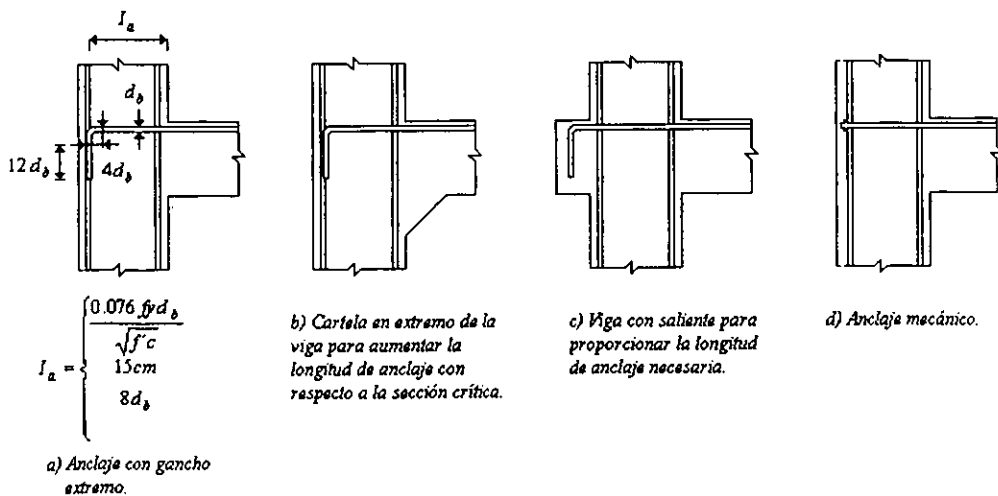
Anclaje del refuerzo longitudinal en vigas extremas de marcos de concreto.
